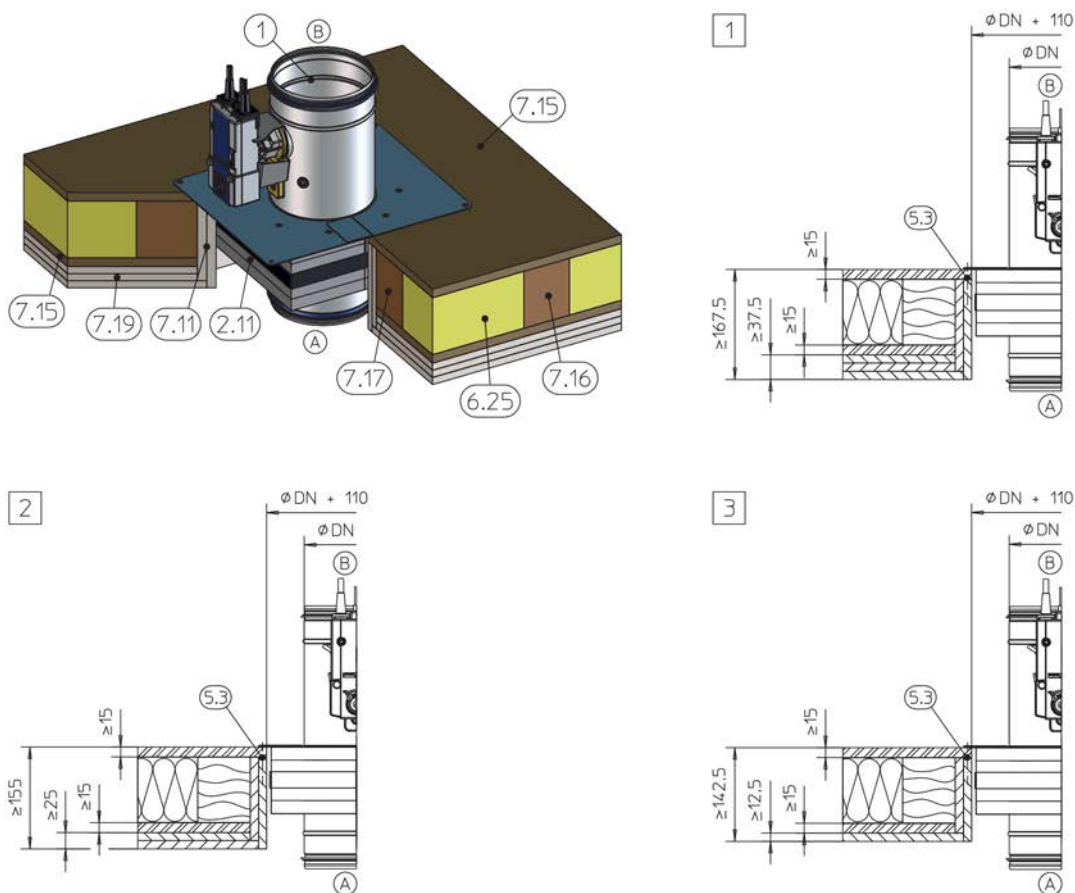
Installazione a base di malta in soffitti con travi di legno/laminate, sospesa (illustrazione rappresentativa, esecuzione alternativa del soffitto possibile su richiesta)
